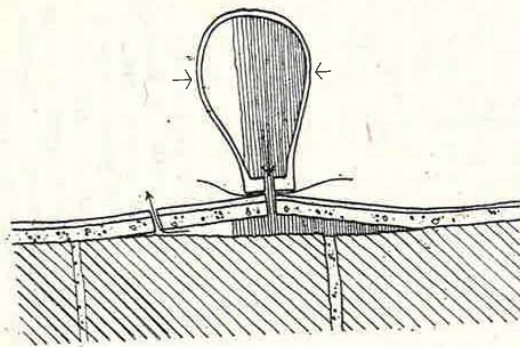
Fixare și consolidare prin injectare cu o pară de cauciuc.
